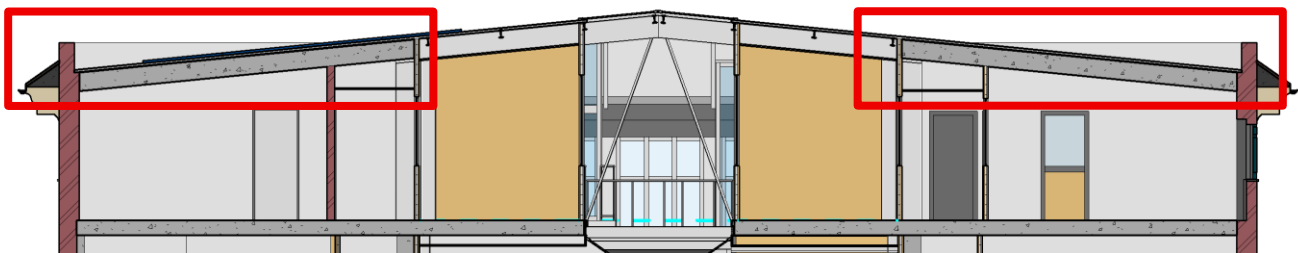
Sezione copertura con individuazione struttura in cemento armato
